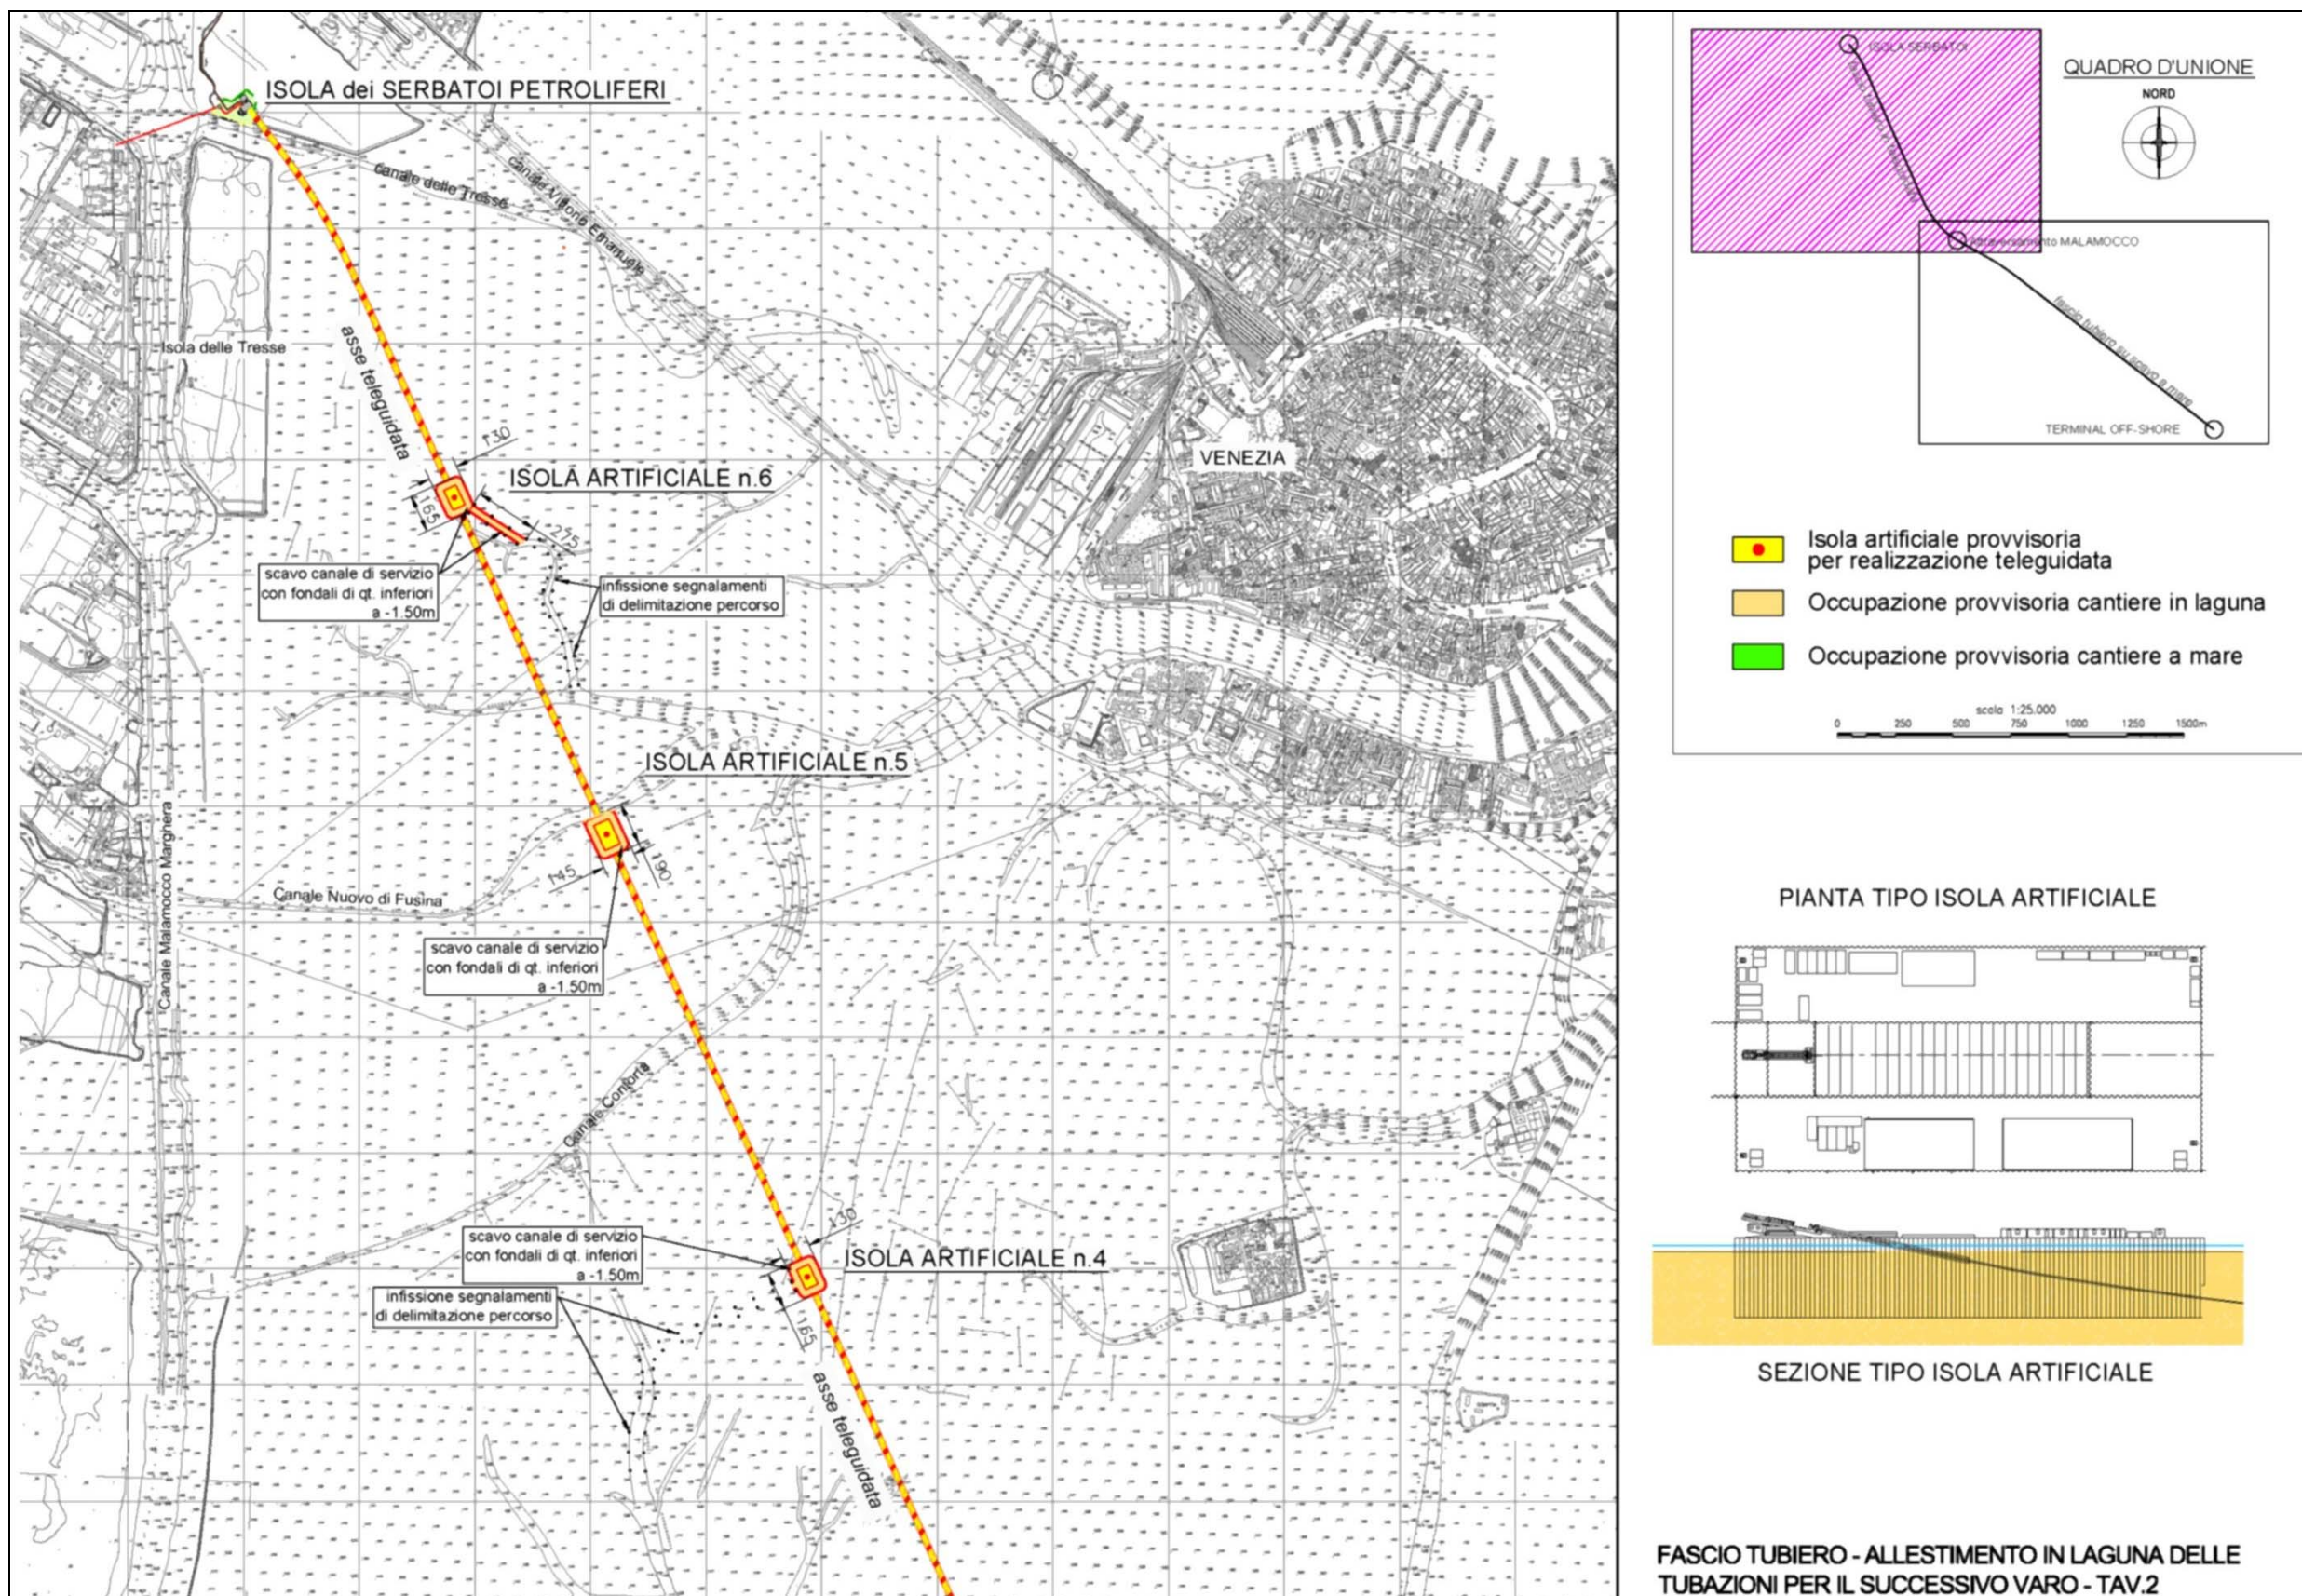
Planimetria isole artificiali provvisorie con canali di accesso – Tavola 2 di 2.
